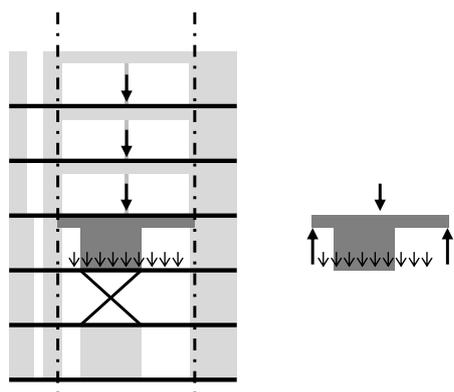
Paroi avec ouvertures et poutre cloison pour le cas exceptionnel
